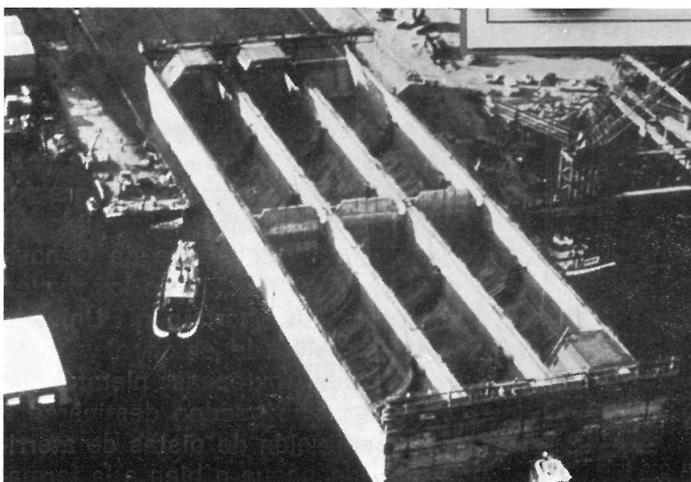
Construcción de gabarras de hormigón pretensado para constituir el casco de plantas flotantes para licuación y almacenamiento de gas natural.
